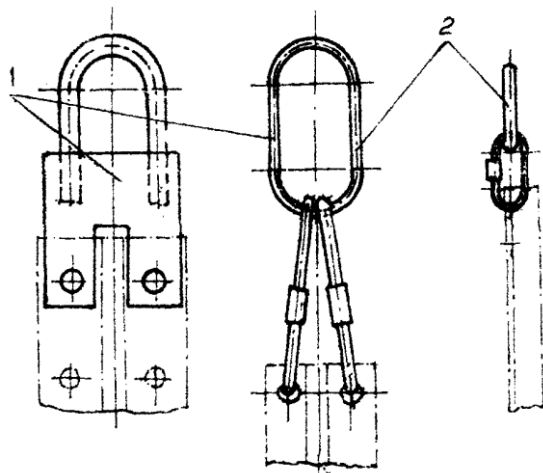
Захваты для монтажа направляющих кабины и противовеса:
